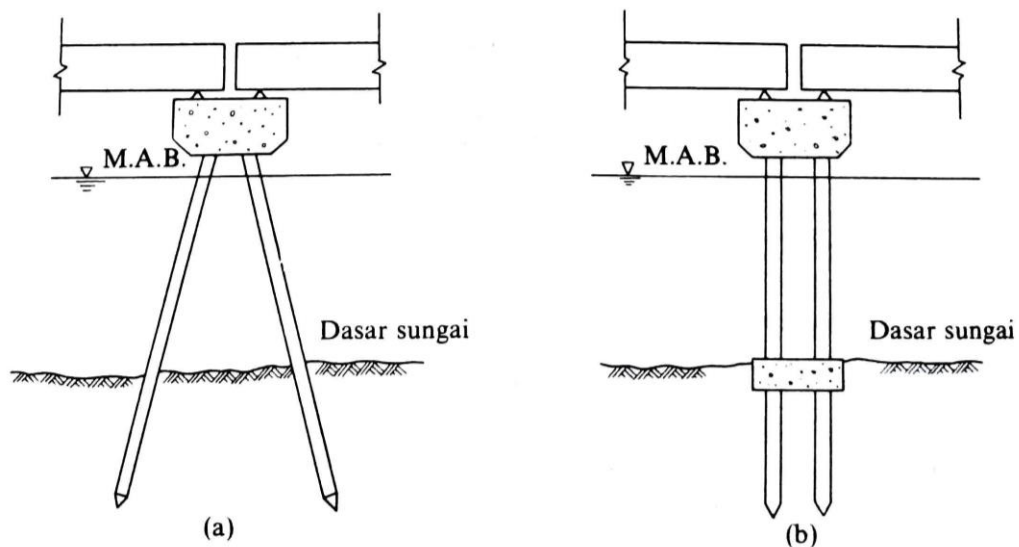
Bentuk umum pilar jembatan yang dibangun di sungai
